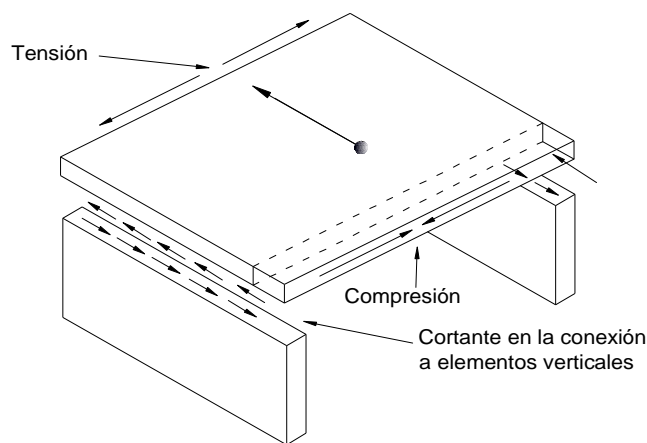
Fuerzas desarrolladas en un diafragma rígido.
